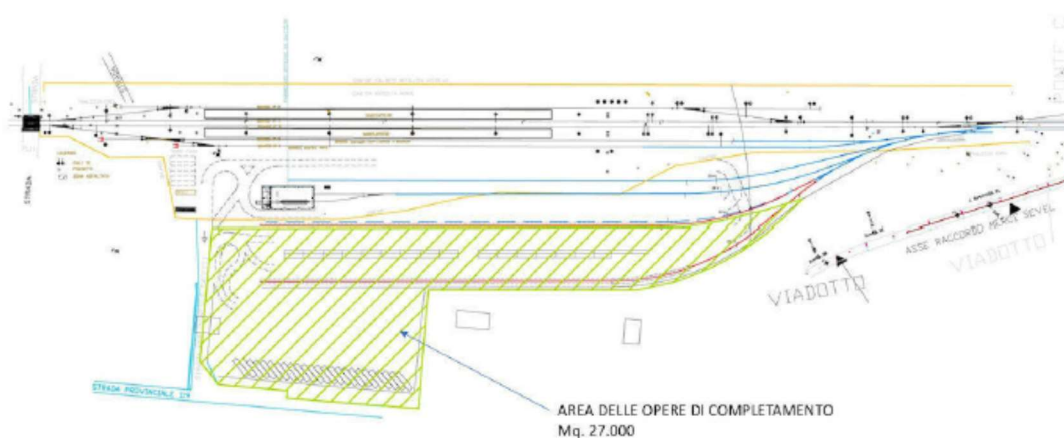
Stralcio planimetrico intervento Scalo Saletti
